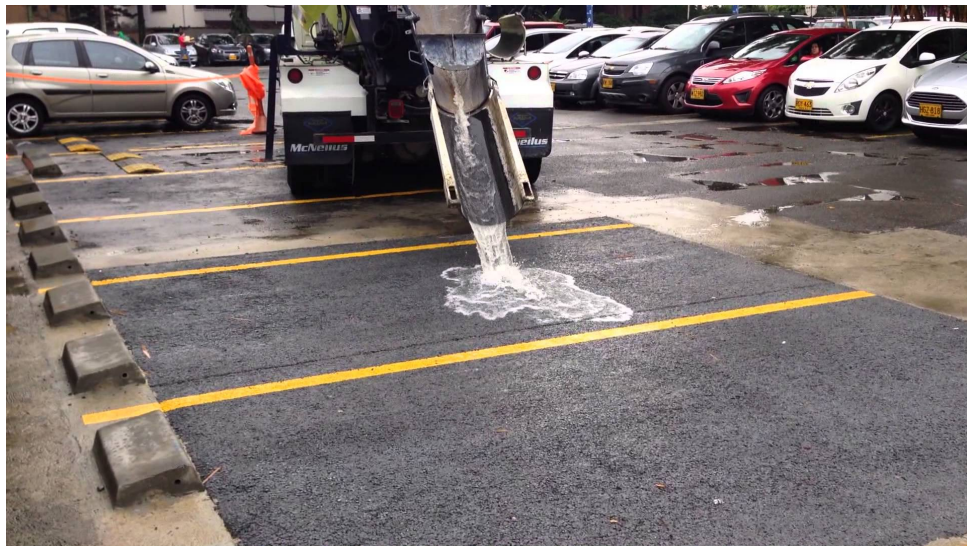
Banda de aparcamiento construida con hormigón drenante
